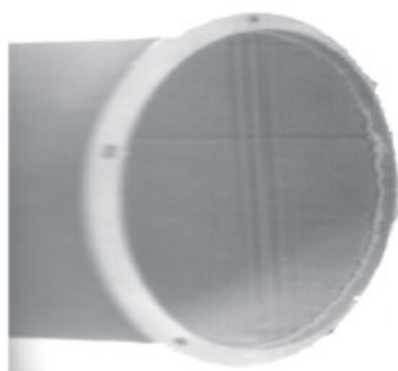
Фланец, насаженный на круглый воздуховод
